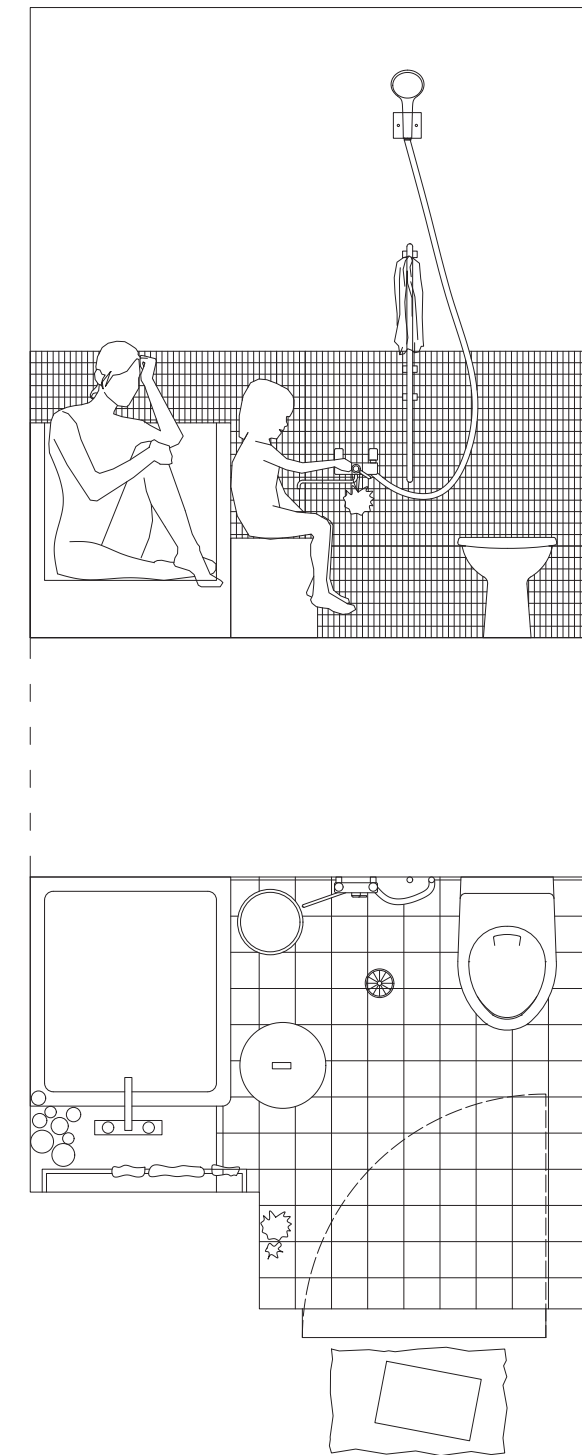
(*Une Affaire de f.*) Mise en plan et en coupe de la salle de bain
